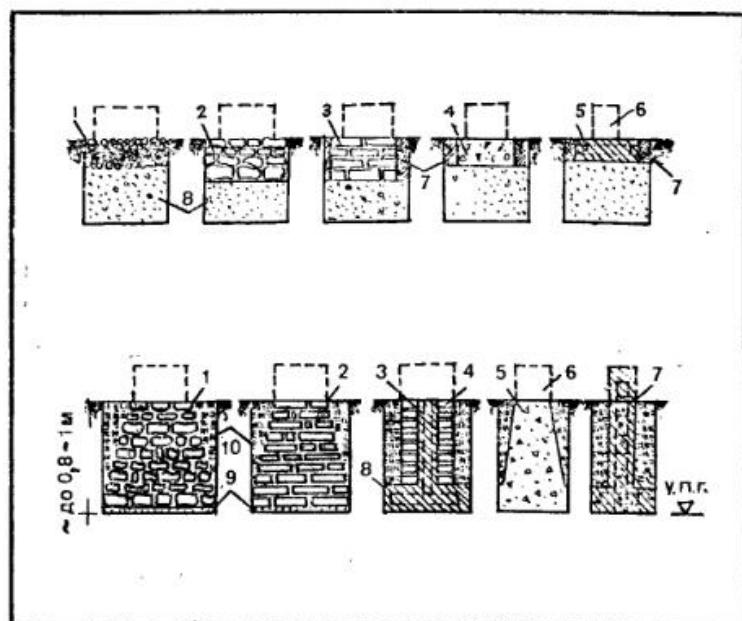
Верхний ряд. Столбчатые и ленточные фундаменты, устраиваемые в неподвижных (непучинистых) грунтах:
